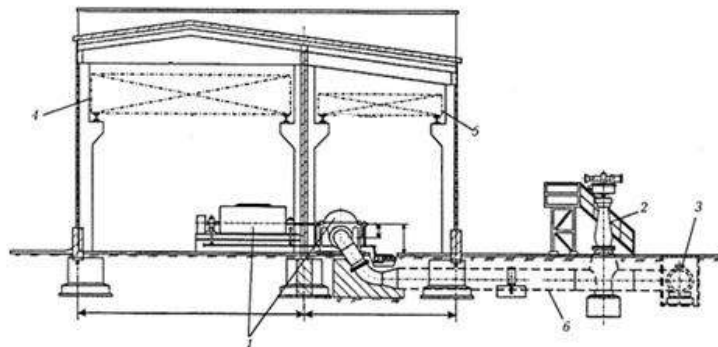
Насосный цех, оборудованный насосными агрегатами НМ- 10000-210:
